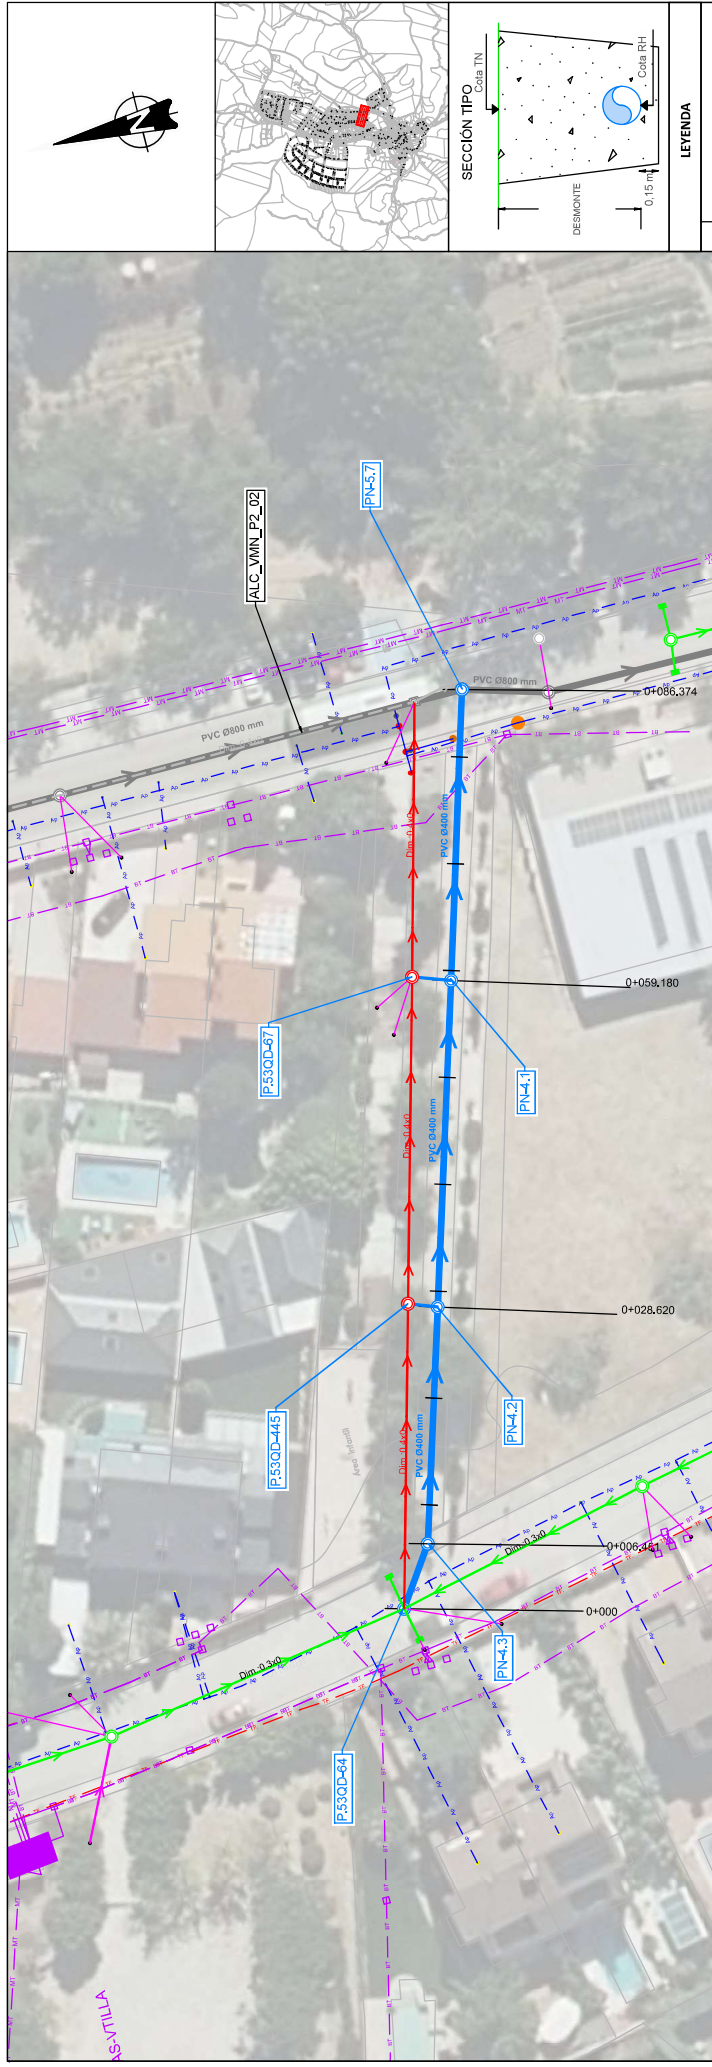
Planta de las actuaciones proyectadas.
